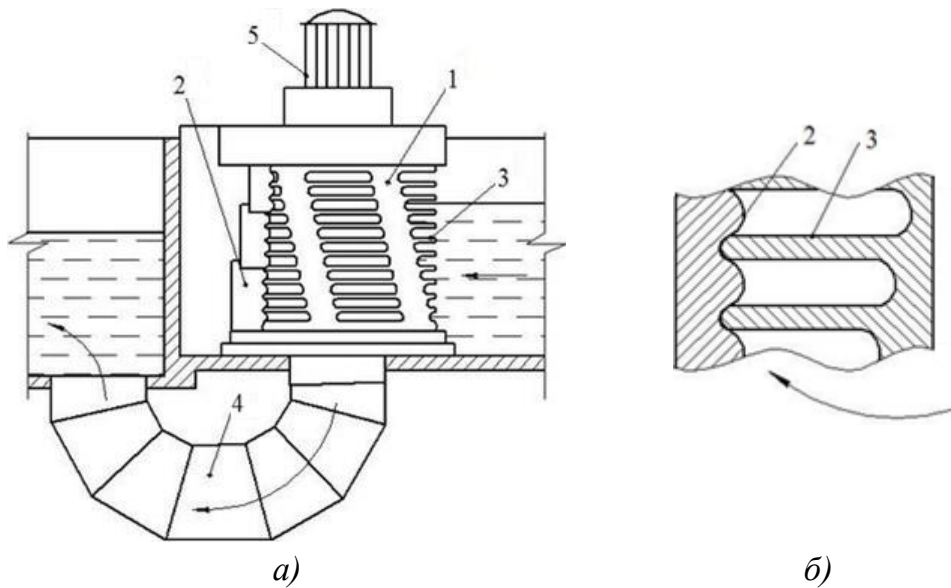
Решетка-дробилка типа РД: а – общий вид; б – схема измельчения: 1 – щелевой барабан; 2 – трепальные гребни; 3 – резцы; 4 – отводной дюкер; 5 – приводной механизм
